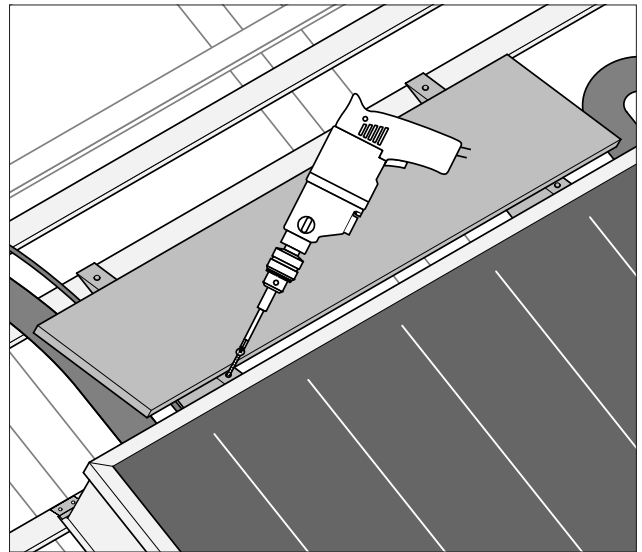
Holzauflagen an Kollektor anlegen und mit Schnellbauschrauben 4×35 und 5×120 befestigen.
